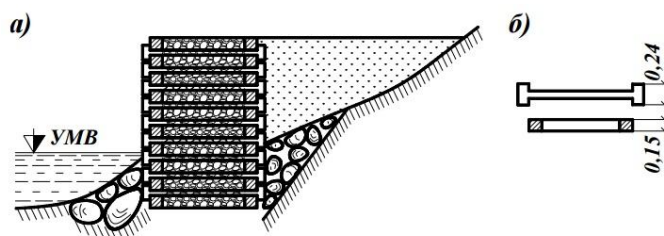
Берегоукрепление железобетонными ряжами:
